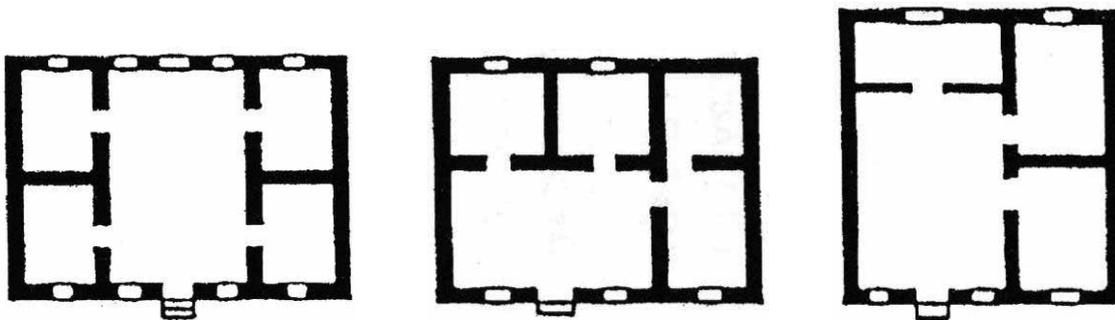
Varianten des Hauses mit Hauptraum und Doppelräumen auf beiden Seiten und dahinter: Grundriss-Schemata
